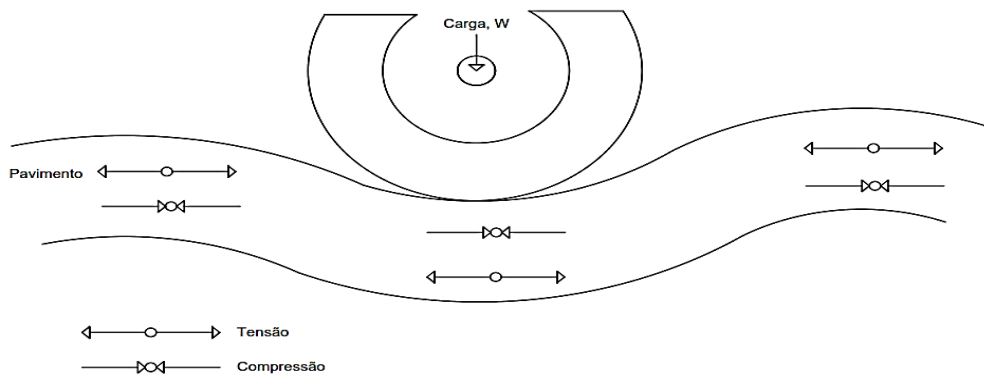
Efeito esquemático da deflexão de um pavimento sob ação do tráfego, resultando em tensões de compressão e de tração nas camadas ligadas (Asphalt Institute, 1981)
